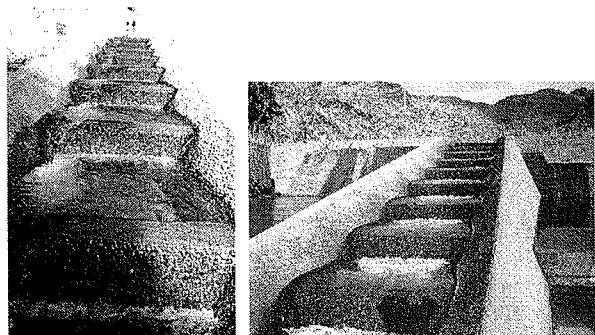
1/7 勾配を有する台形断面プール式階段魚道
